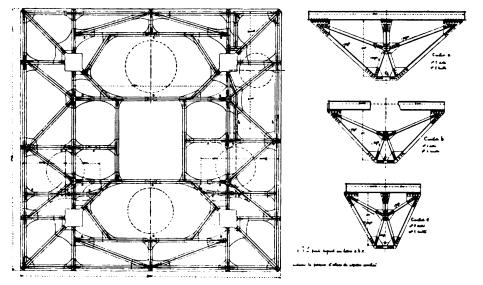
Castello campanario in ferro. Pianta e prospetti dei cavalletti sorreggenti le campane
